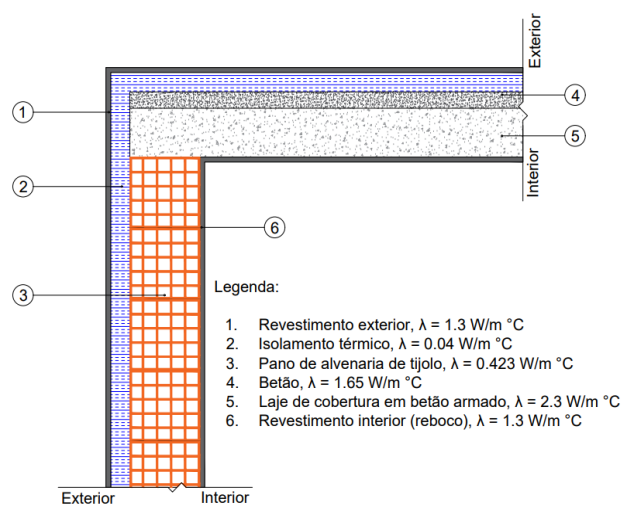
Pormenor construtivo da ligação entre fachada e cobertura com parede simples em alvenaria de tijolo e laje de cobertura isoladas de forma contínua pelo exterior.
